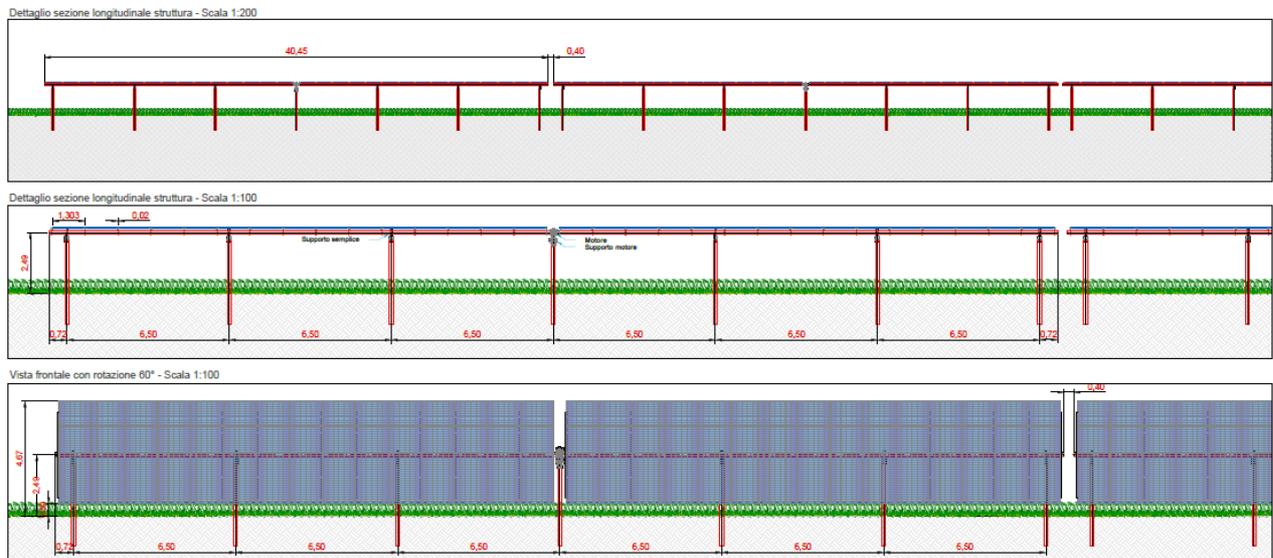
Sezione longitudinale tipologica struttura Tracker
